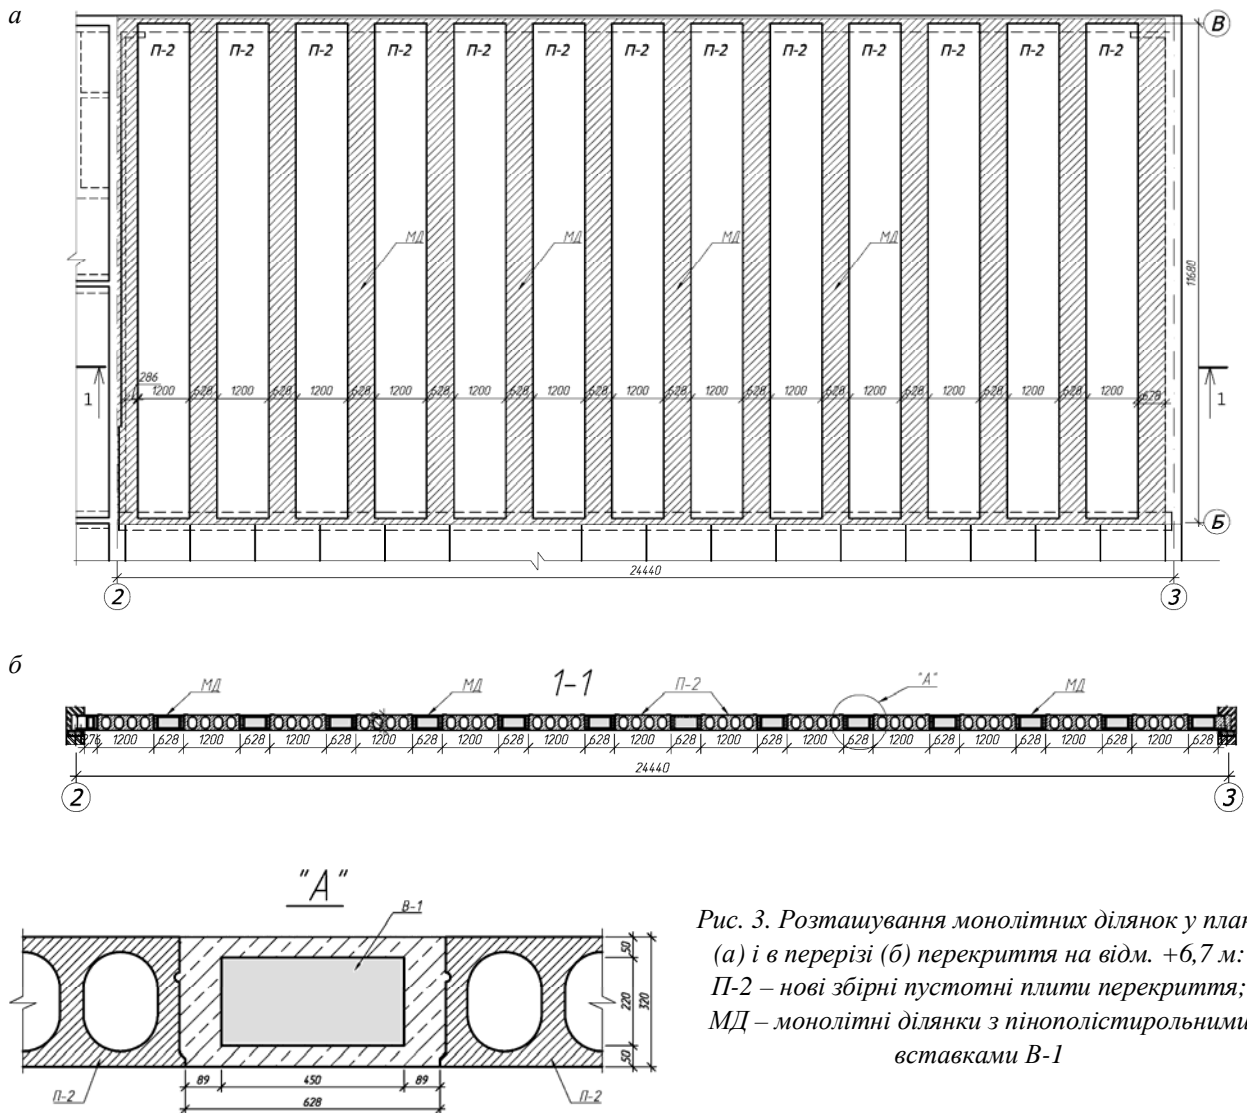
Розташування монолітних ділянок у плані (а) і в перерізі (б) перекриття на відм. +6,7 м: П-2 – нові збірні пустотні плити перекриття; МД – монолітні ділянки з пінополістирольними вставками В-1
